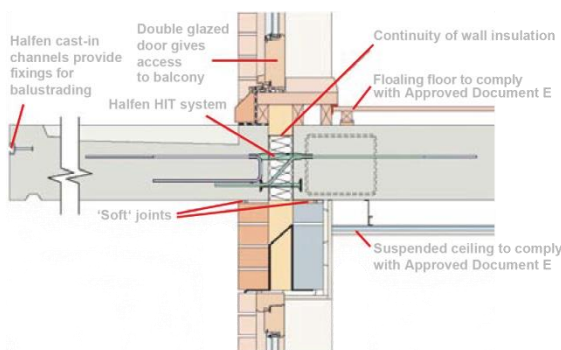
Теплоизолированное присоединение железобетонного балкона к междуэтажному перекрытию фирмы HALFEN DEHA предотвращает образование теплового моста
